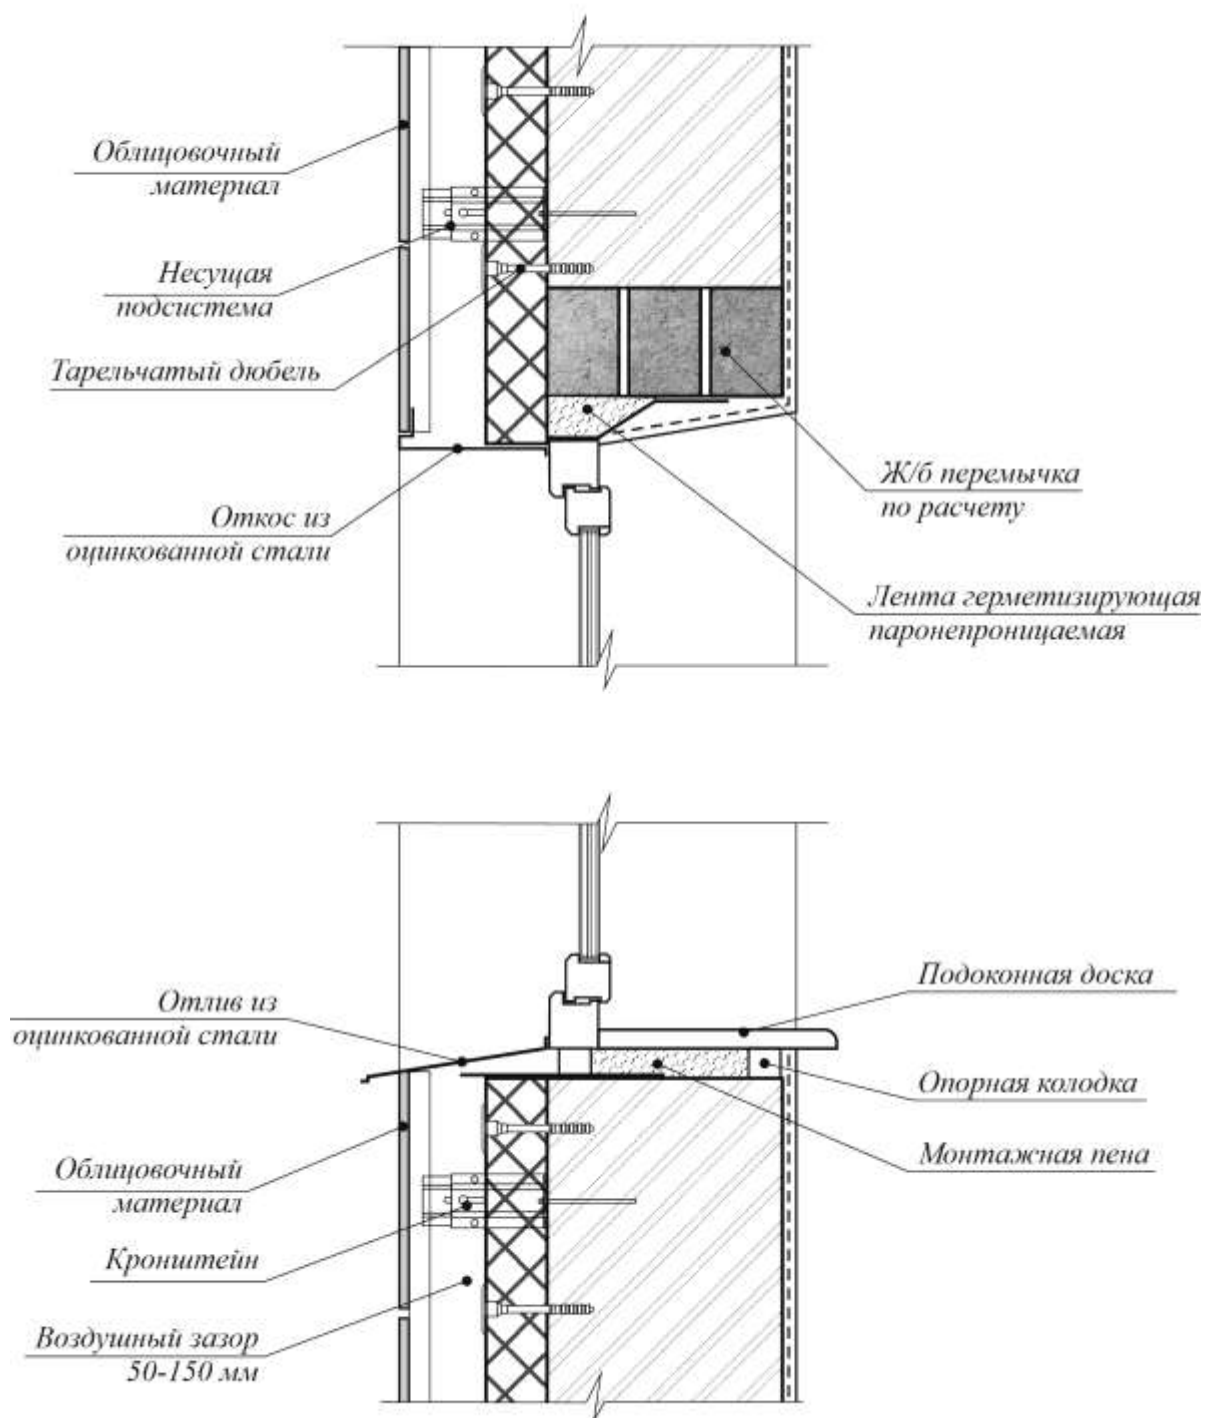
Узлы устройства оконного проема в наружной стене с системой навесного фасада
